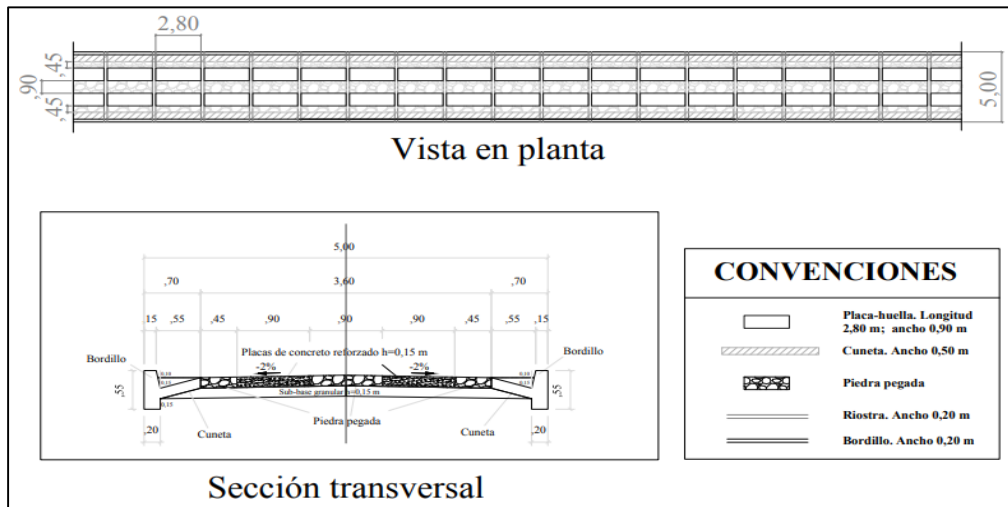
Diseño estructural con corte trasversal y vista en planta para el séptimo tramo.
